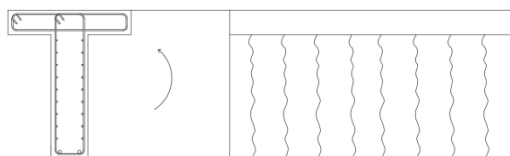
Propagação das fendas numa viga com armadura lateral de reforço na alma.
